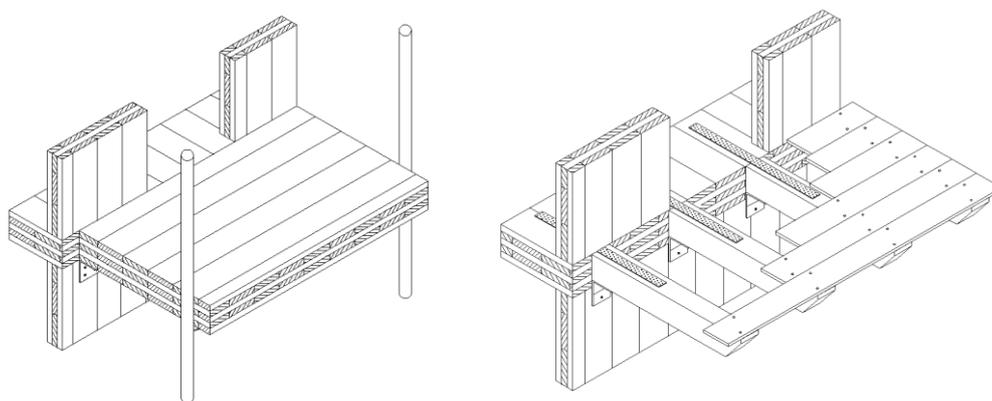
Balcone realizzato mediante un pannello XLAM in appoggio su staffe metalliche fissate alle pareti perimetrali e su pilastri esterni oppure mediante travetti a sbalzo, ancorati a taglio con squadrette metalliche e a flessione con nastri forati
